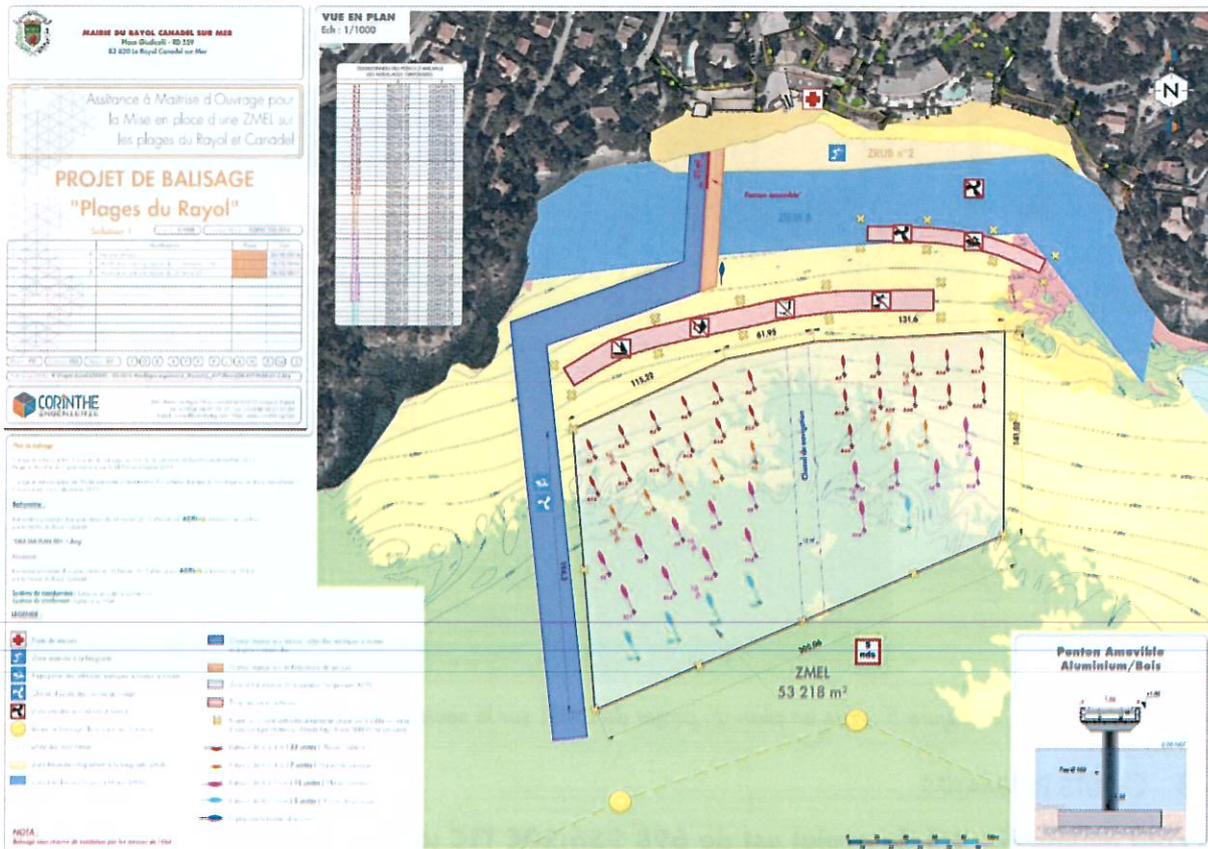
Vue en plan du projet de ZMEL sur le secteur du Rayol
